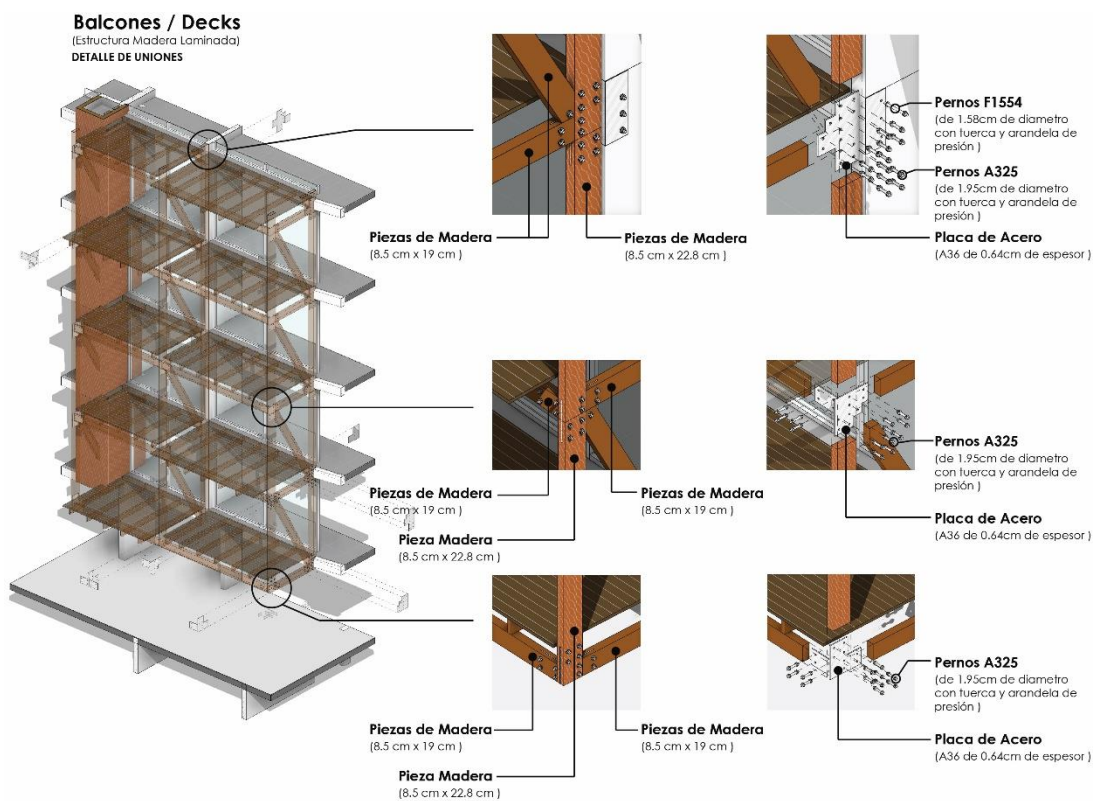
Detalle de piezas y uniones en balcones. Fuente: Elaboración propia
